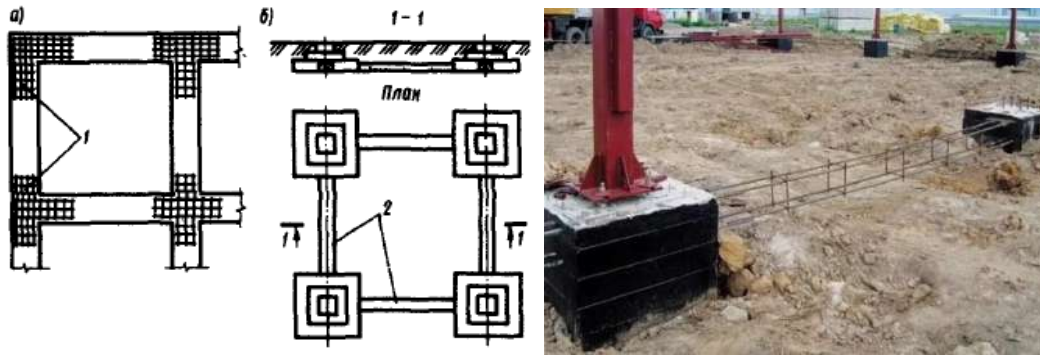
Примеры существующих конструкций сейсмостойких фундаментов: а-ленточный, б – столбчатый; 1-арматурная сетка, 2-фундаментные балки.
